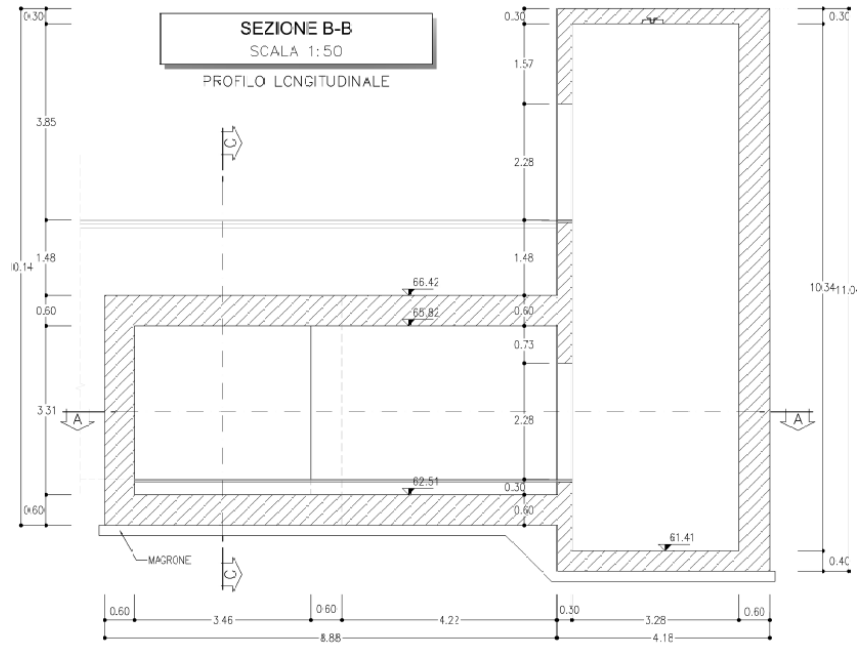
Sezione longitudinale corridoio di collegamento torrino montacarichi
